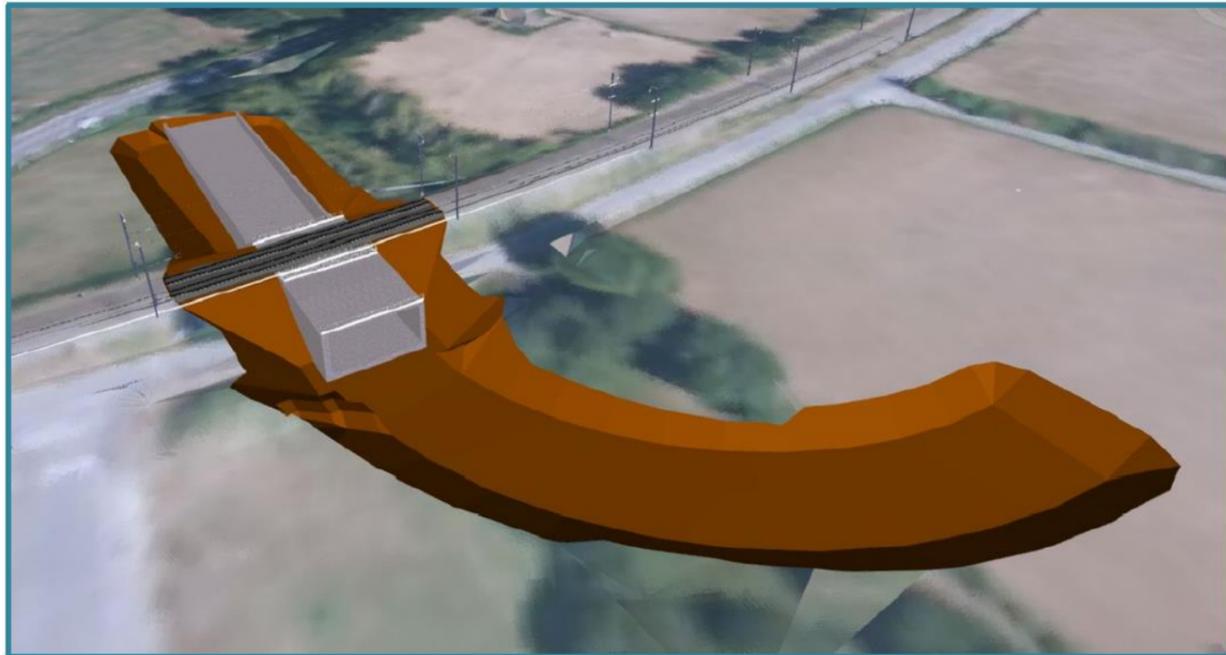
TERRASSEMENT POUR LA RAMPE SUD
